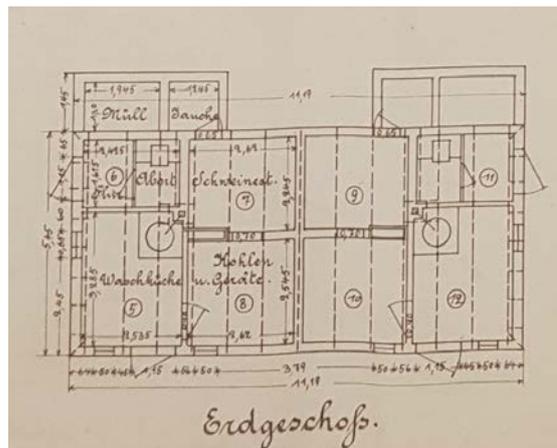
Historischer Grundriss eines Nebengebäudes
